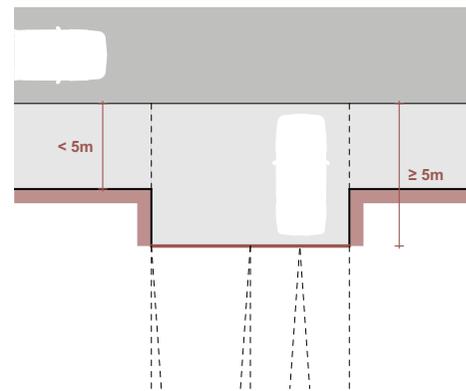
Schema-Grundriss zurückgesetzte Tore
